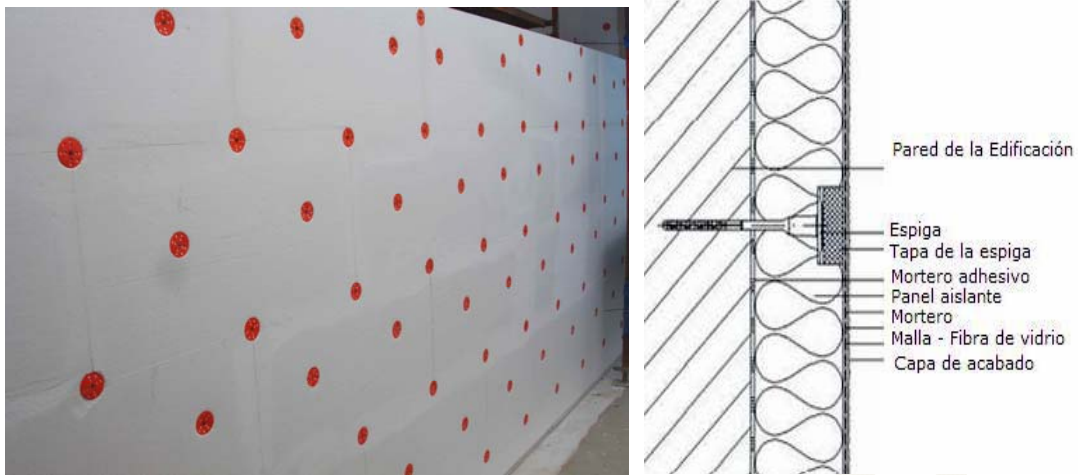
Fotografía de la instalación de espigas en un edificio y sección constructiva de la instalación de una espiga
